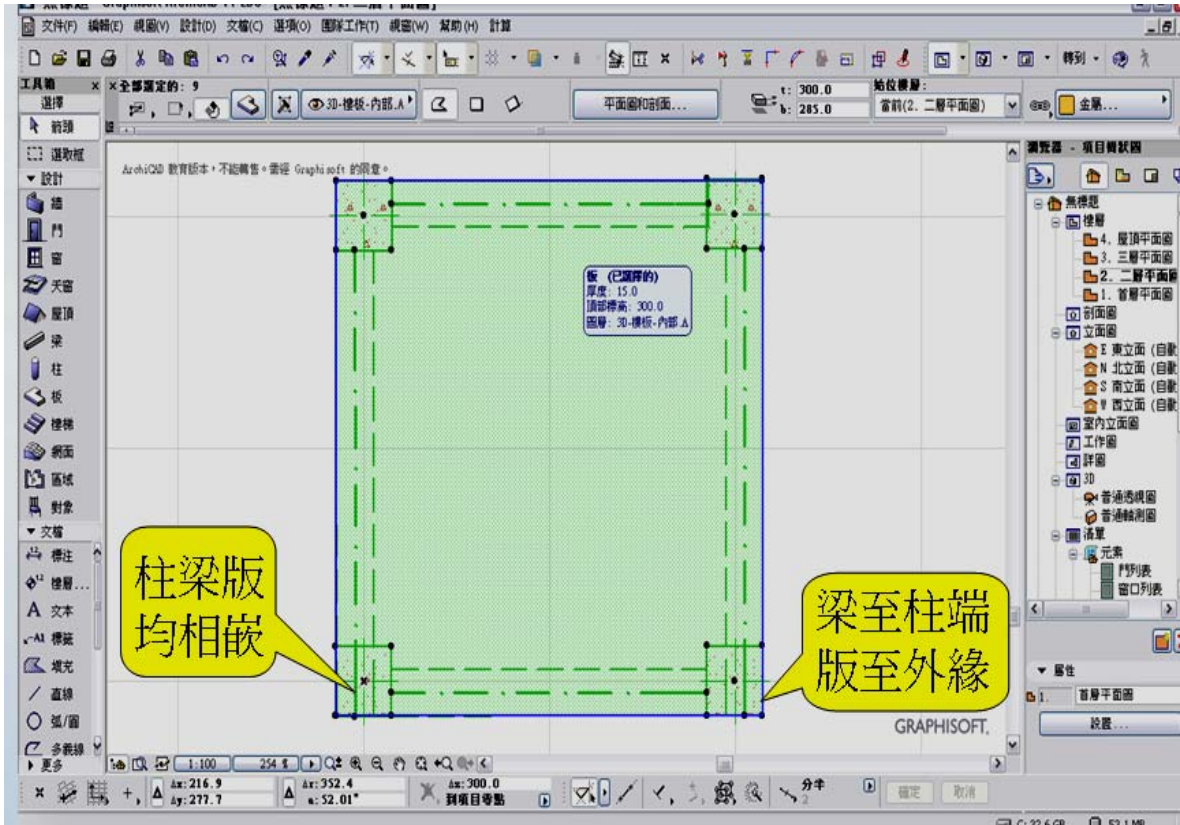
ArchiCAD 柱梁版嵌入模式 2D 平面圖
